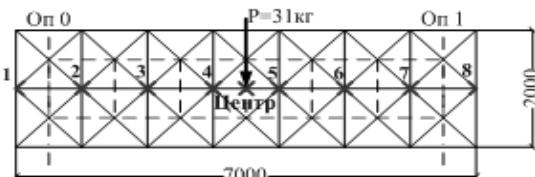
Схема для динамических испытаний на 1-м и 2-м этапе
